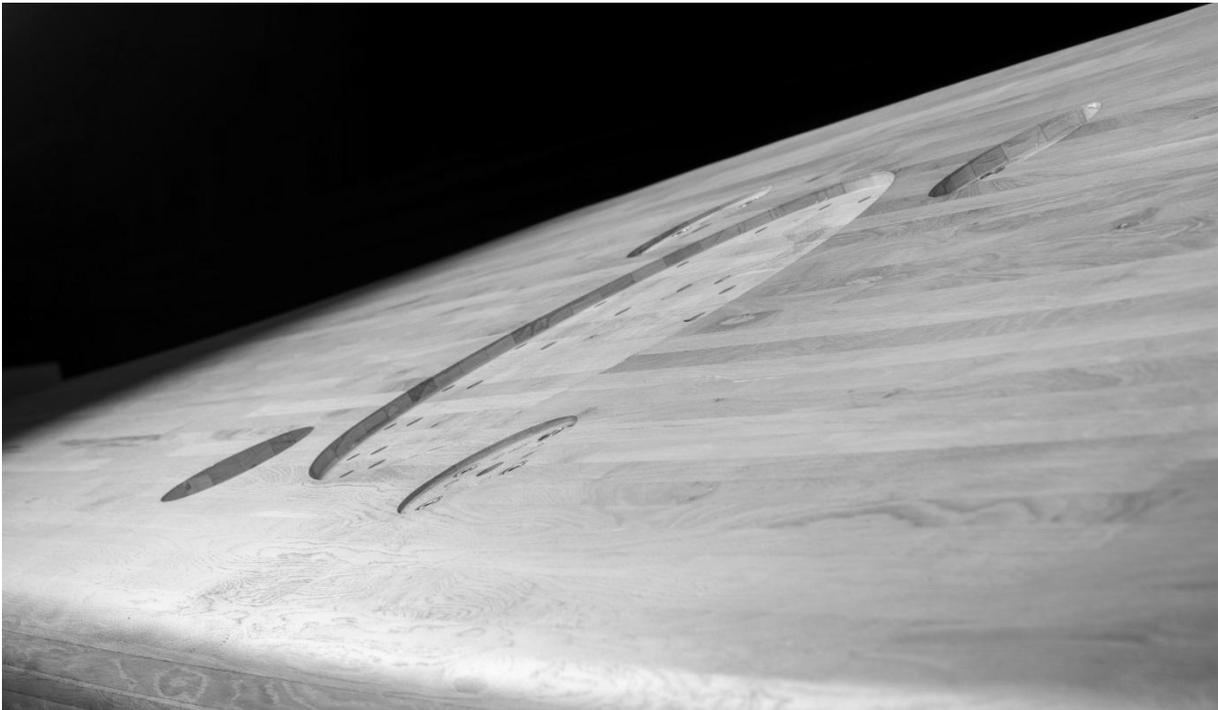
ausgeführte Fräsung für "Spider"-Anschluss
